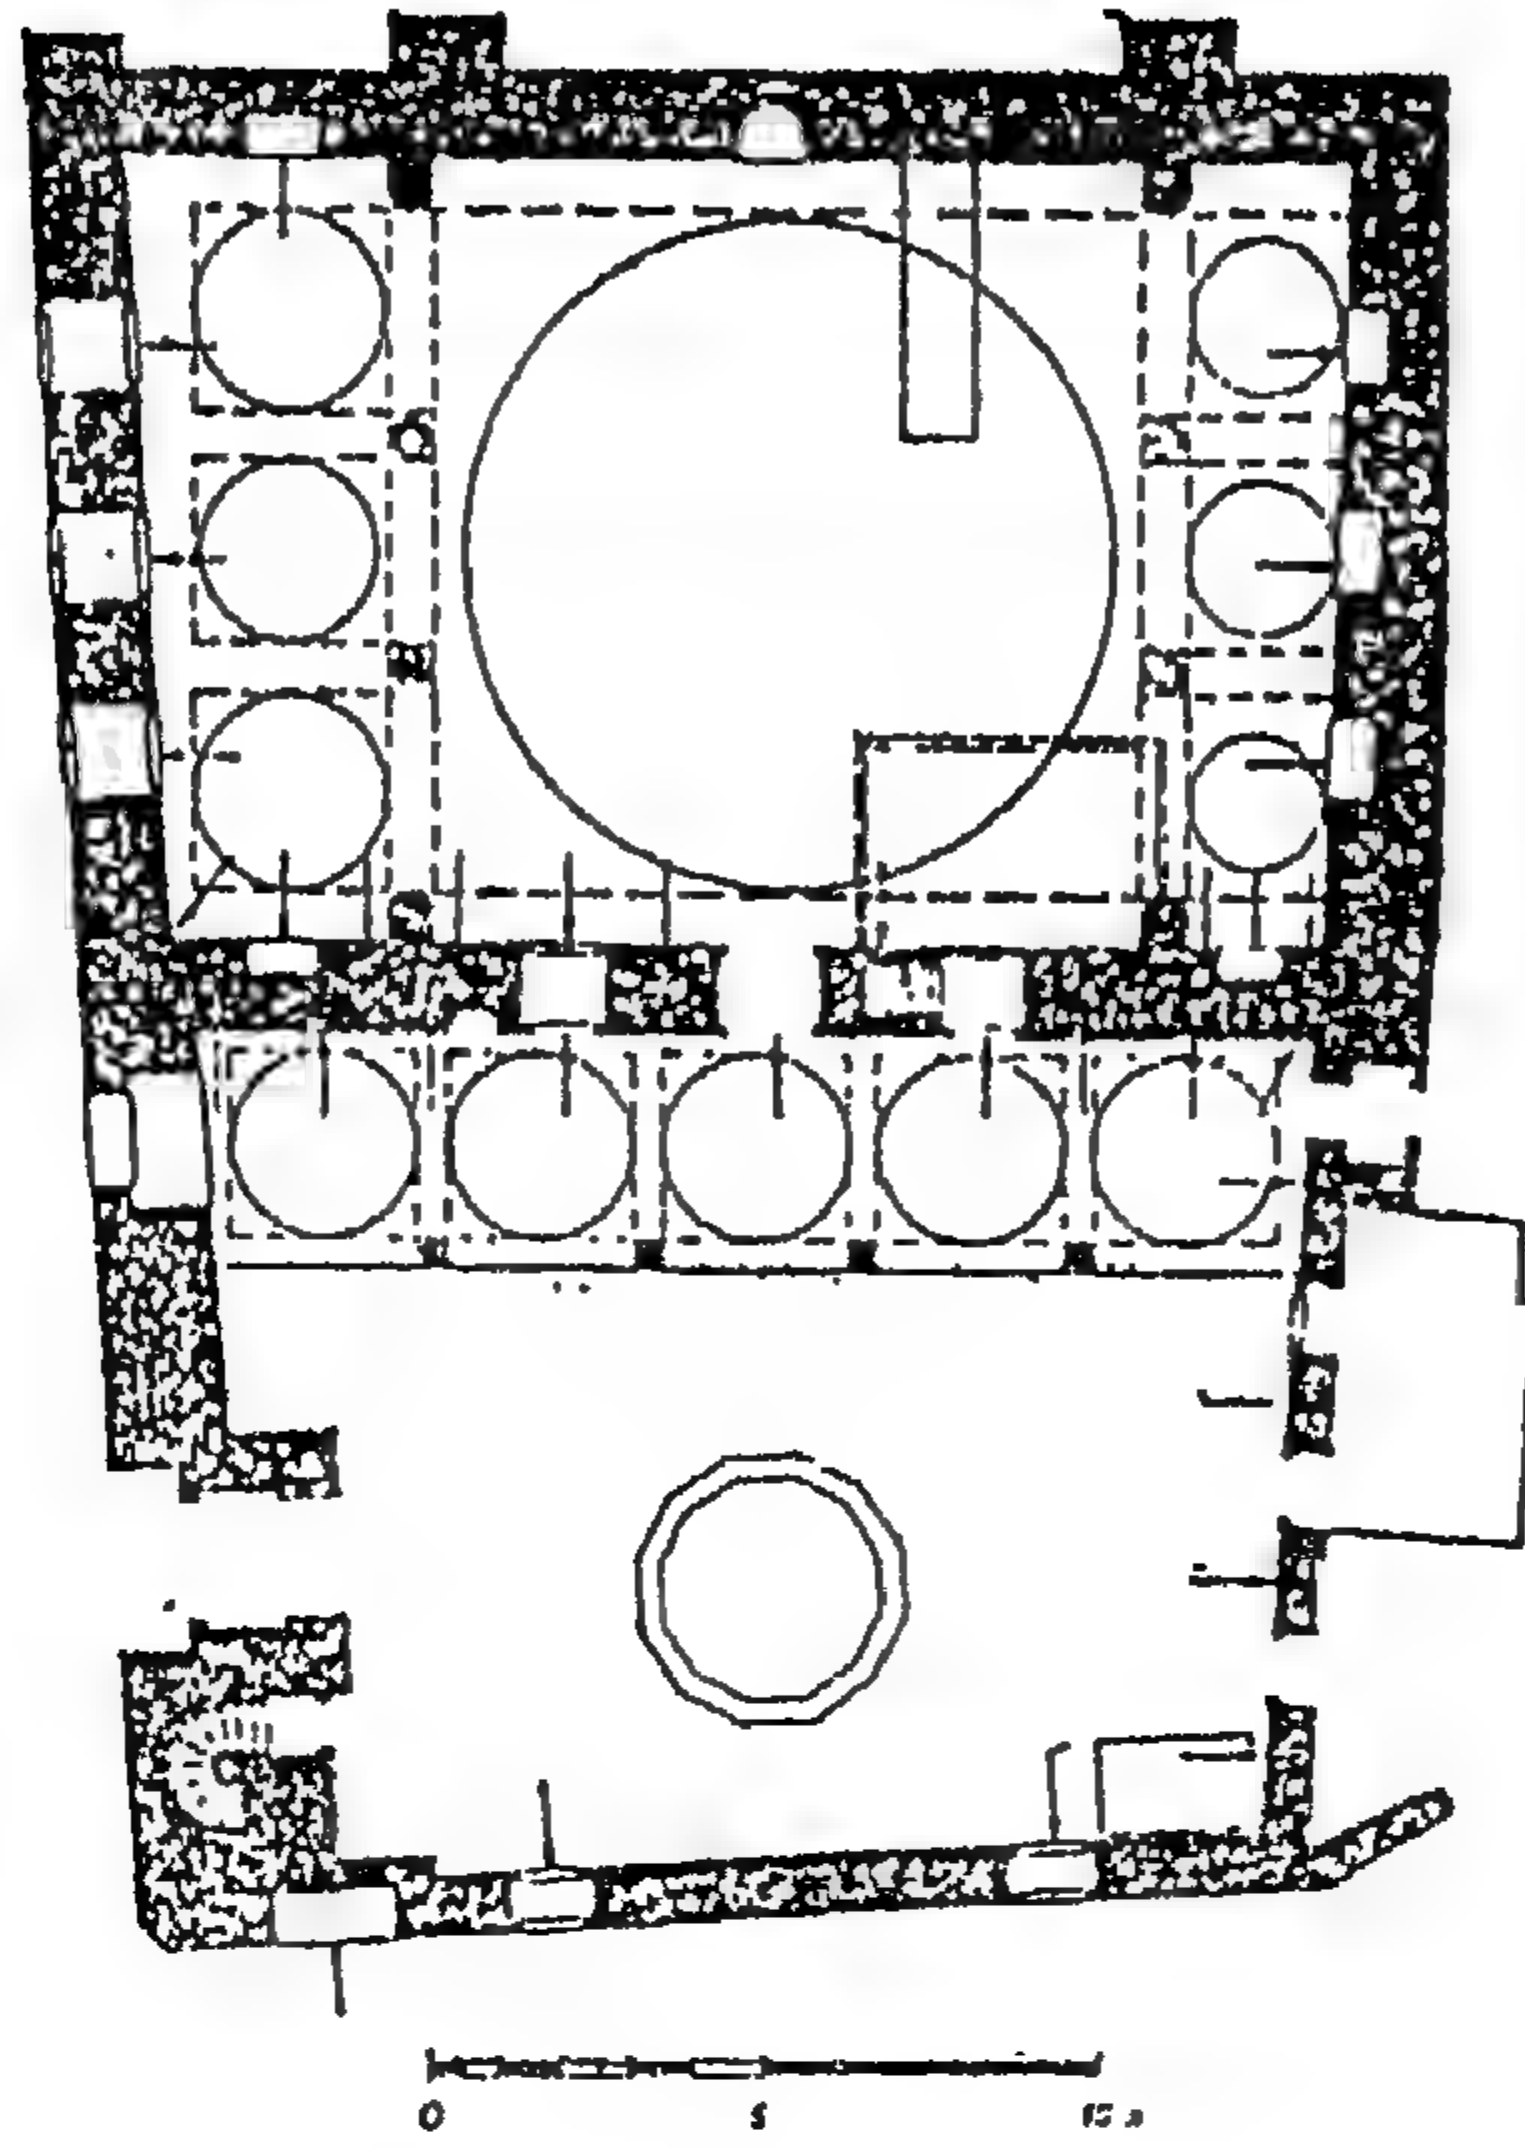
مسقط أفقي لجامع خسروباشا ضمن مجمعه بحلب (عن : جودوين) .
